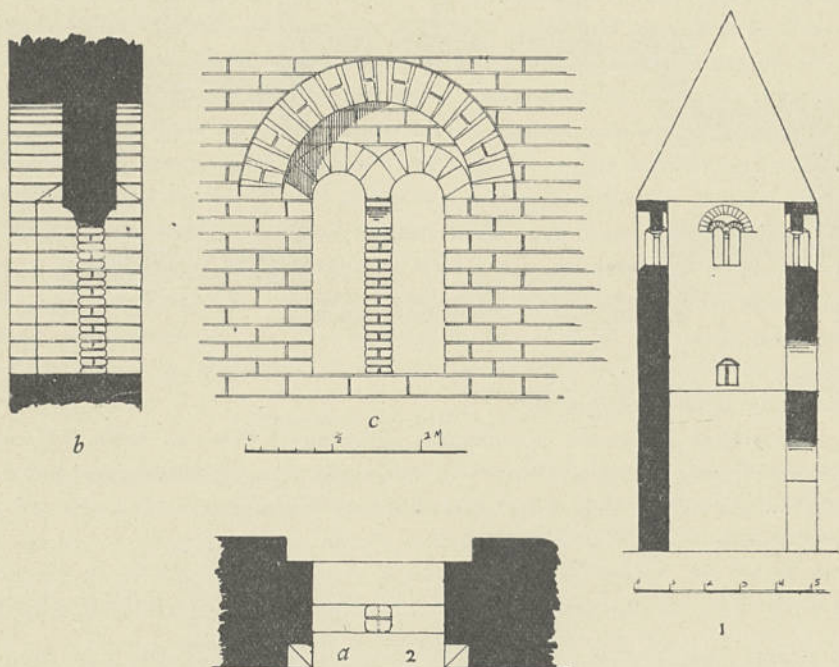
ÉGLISE DE NEERLOON. — 1. Coupe transversale du clocher; 2. Ouïes : a) plan terrier; b) coupe transversale; c) élévation (vue de l'intérieur).
